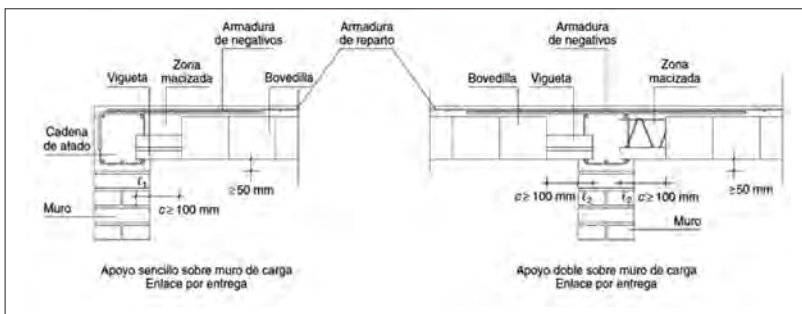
y 20: apoyo sobre muro de carga. Enlace por entrega.
